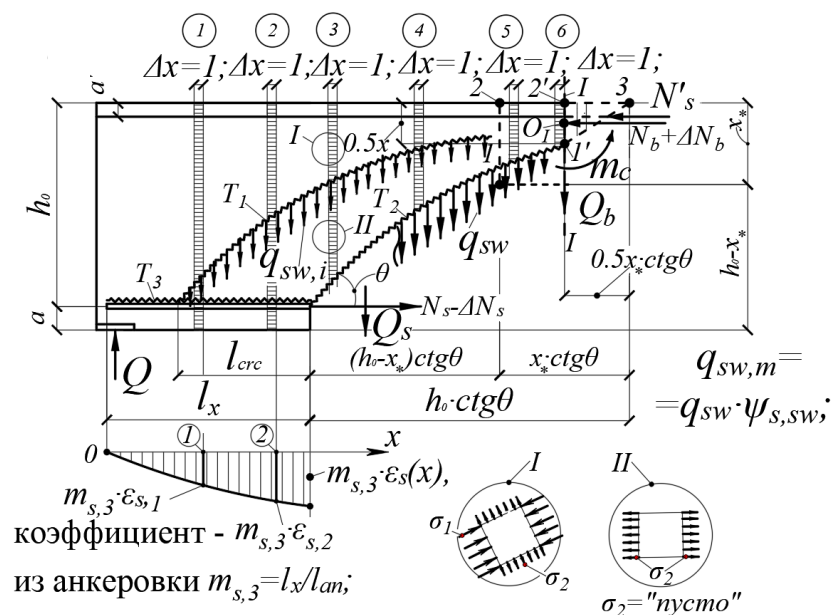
Вторая расчетная модель сопротивления железобетонных конструкций
